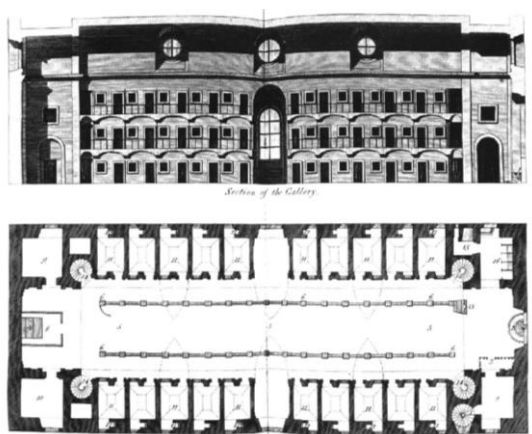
Prisão Papal San Michele (1701). Corte longitudinal e planta baixa
